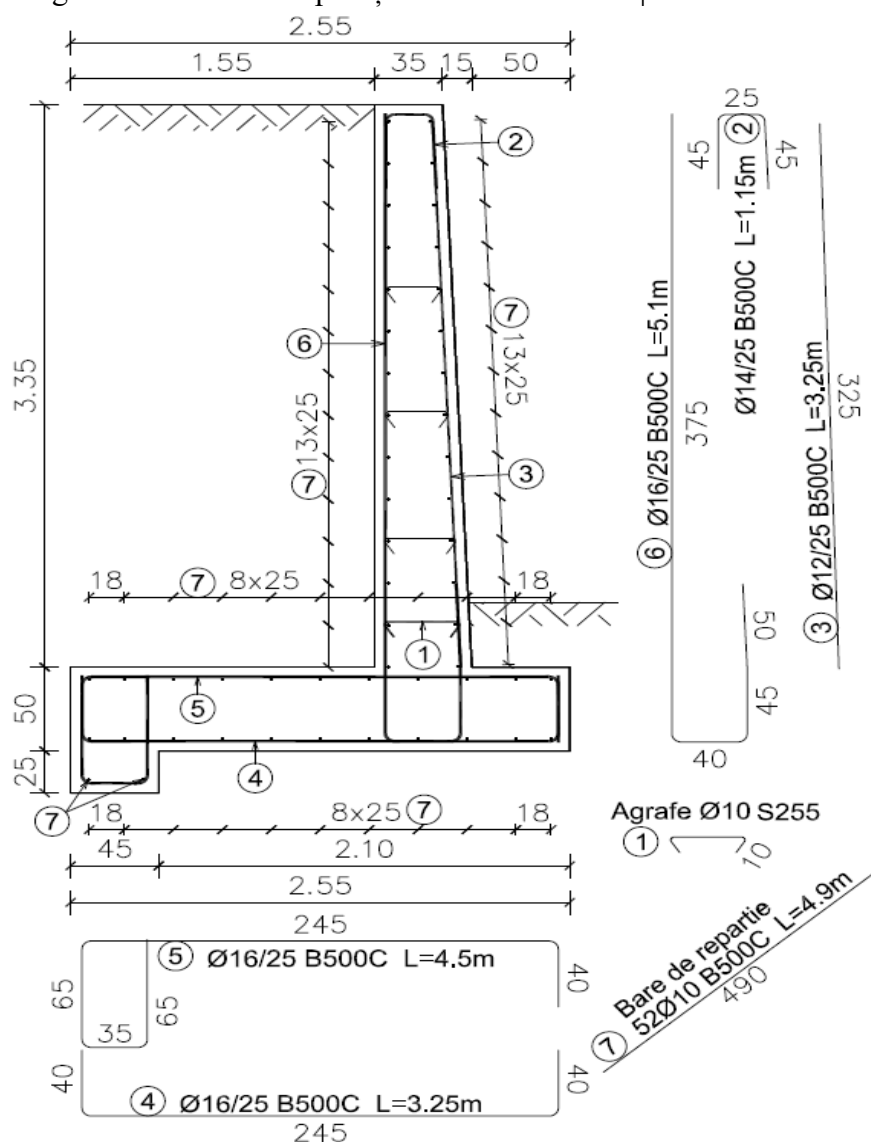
Exemplu orientativ armare tronson zid de sprijin de beton armat.
